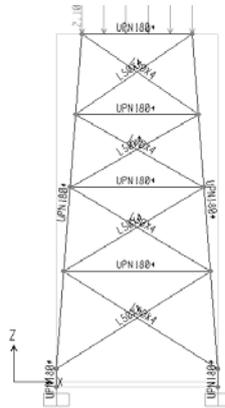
ESTRUCTURA SOPORTE PARA DUCTOS
